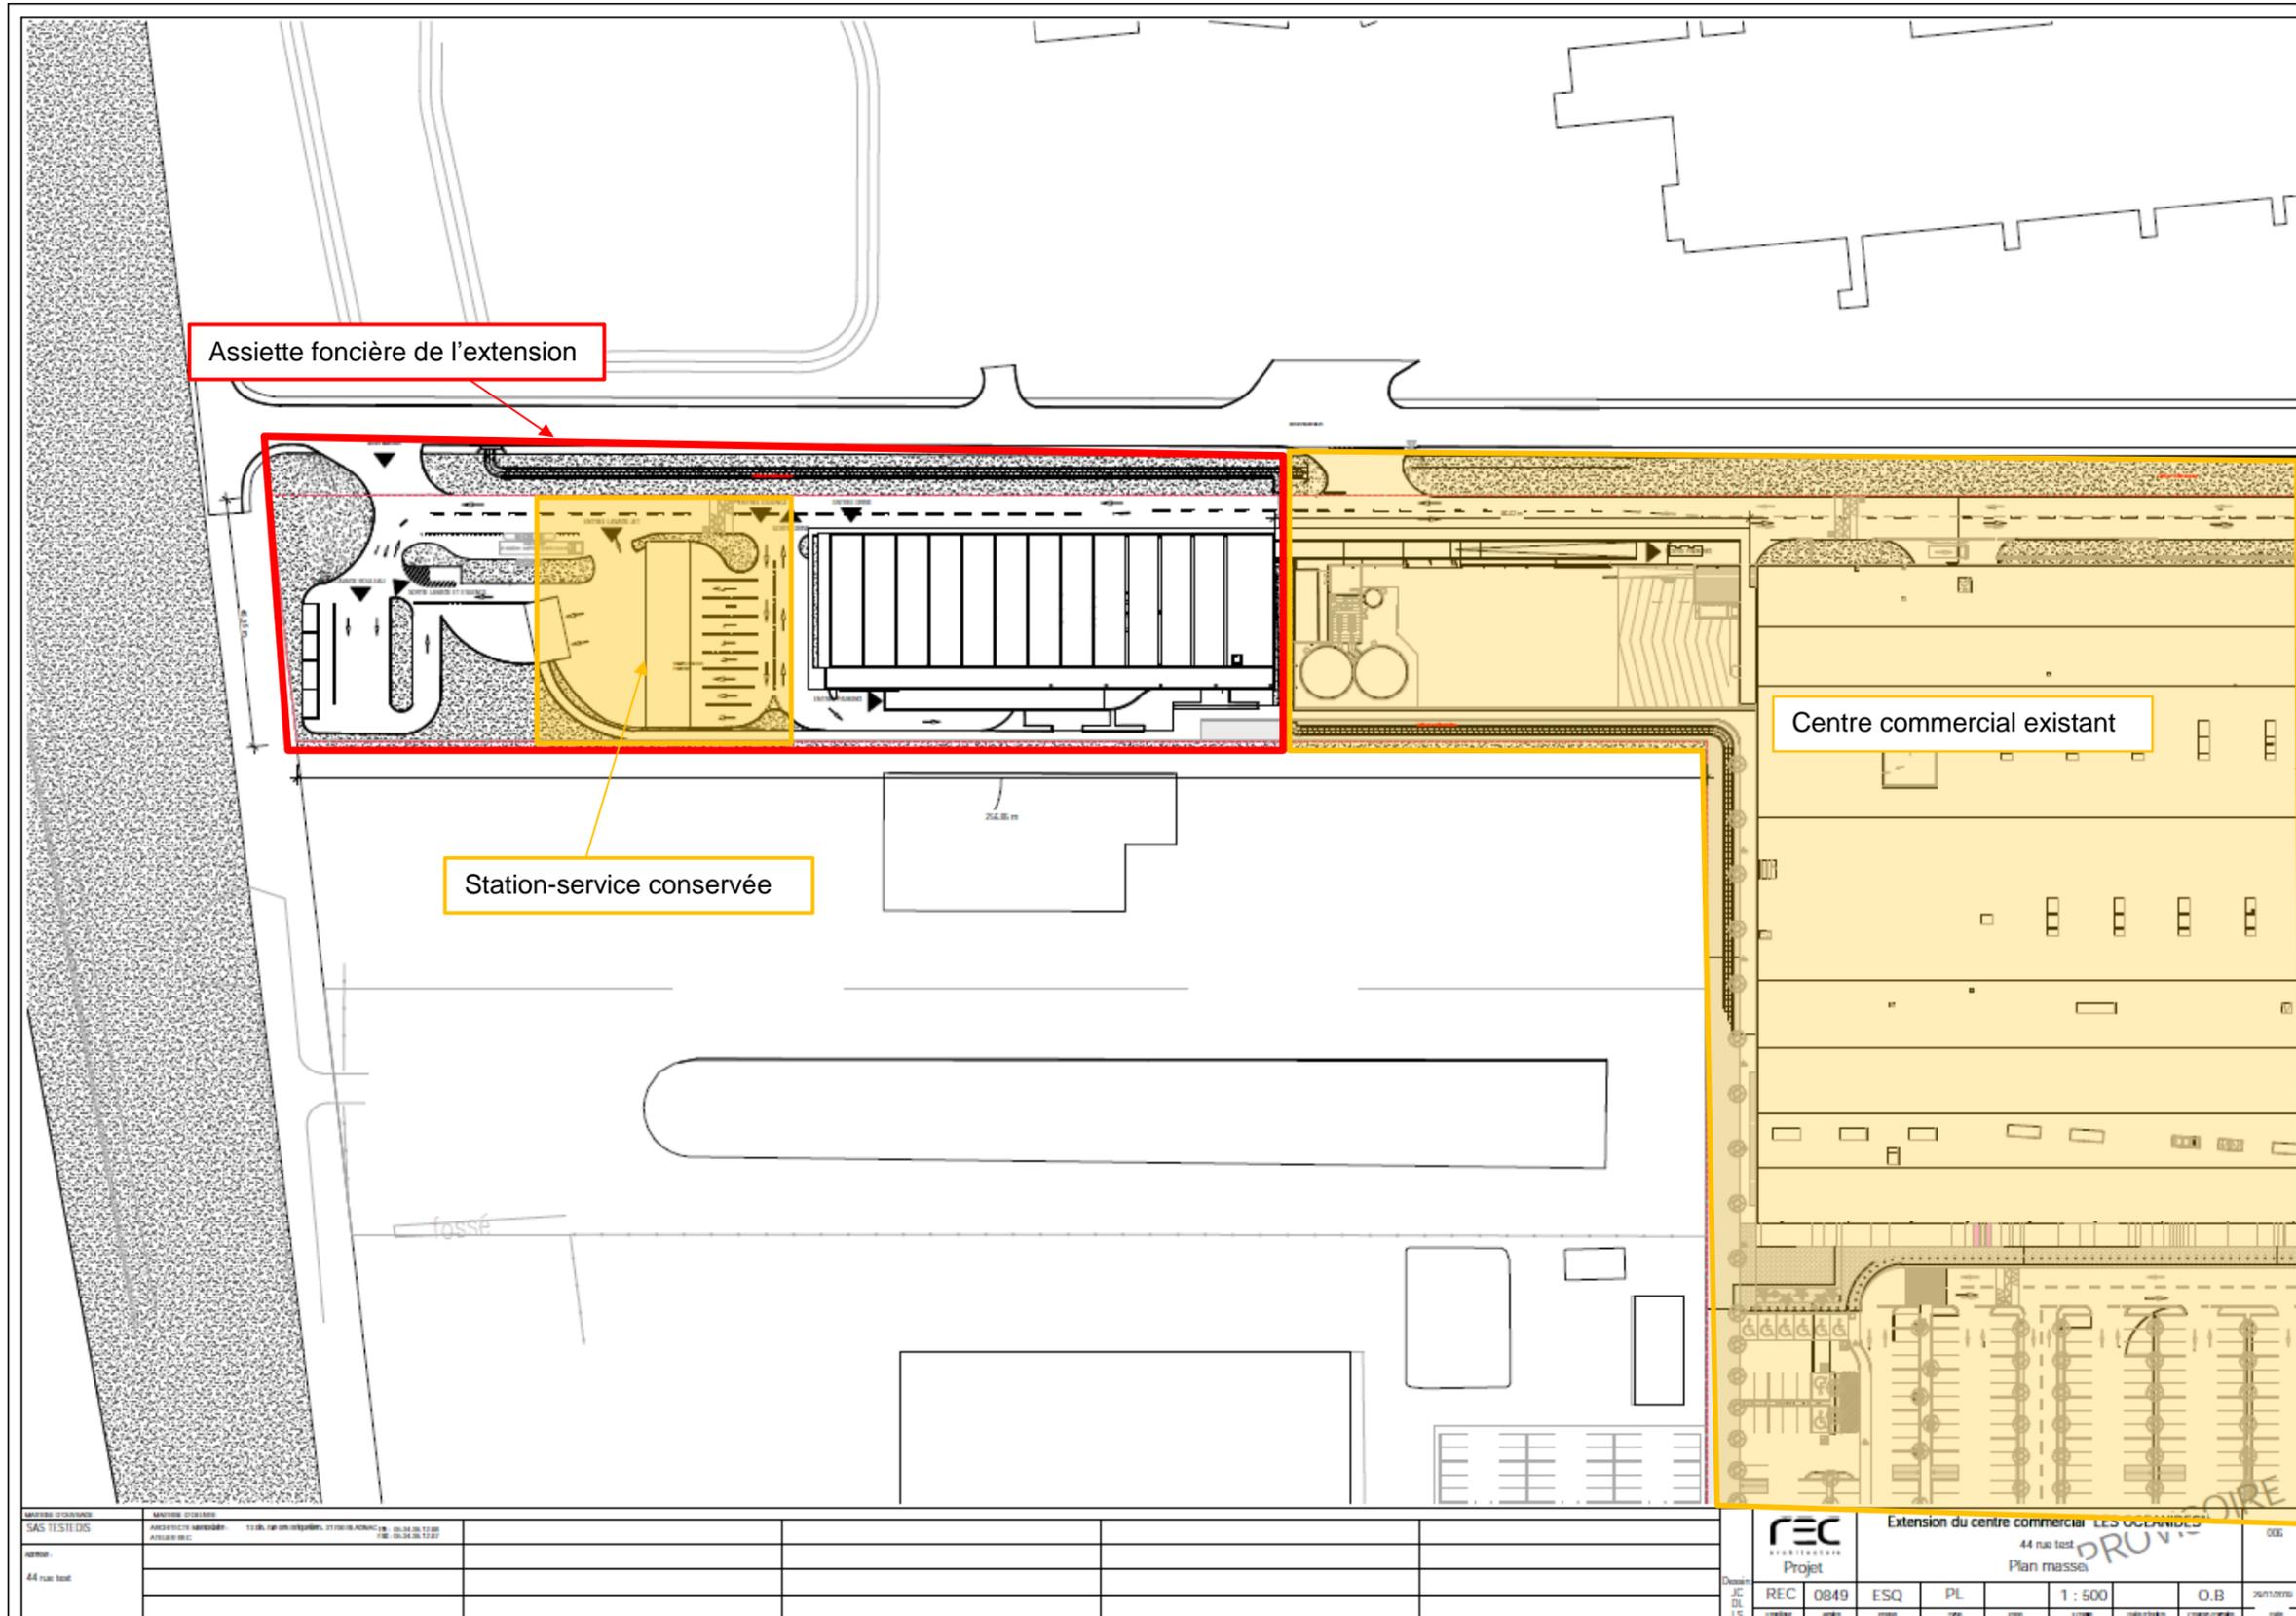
Plan de masse du projet (Source : REC Architecture)
